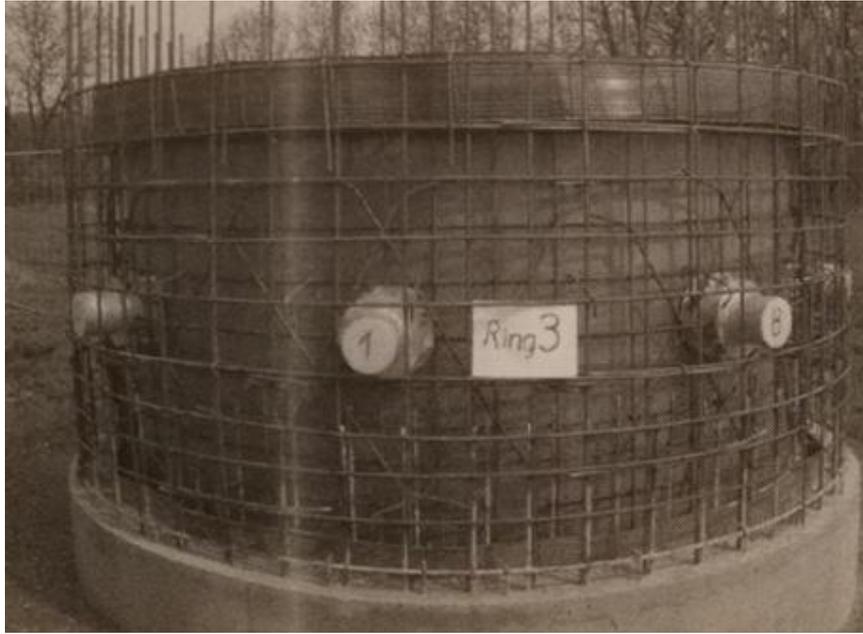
Erstes Segment mit Anschlüssen für die Filterstränge (Nemeček, 2006)
